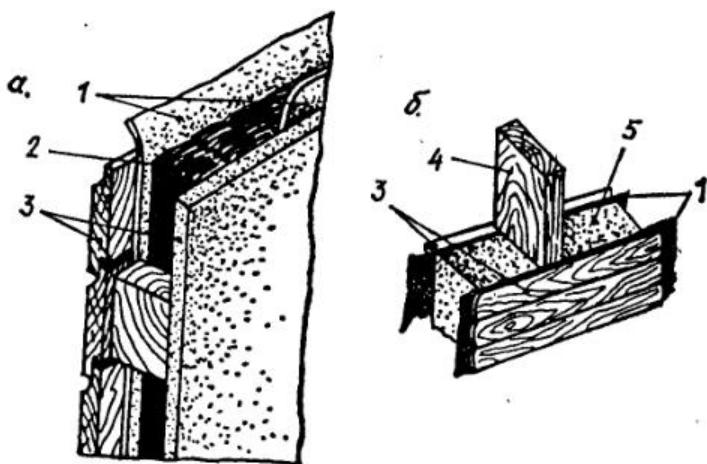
Утепление каркасных стен: а — стекловатой: 1 — толь или рубероид; 2 — стекловата; 3 — обшивка; б — засыпкой: 1 — пергамин или рубероид; 3 — обшивка; 4 — стойка; 5 — засыпка.
